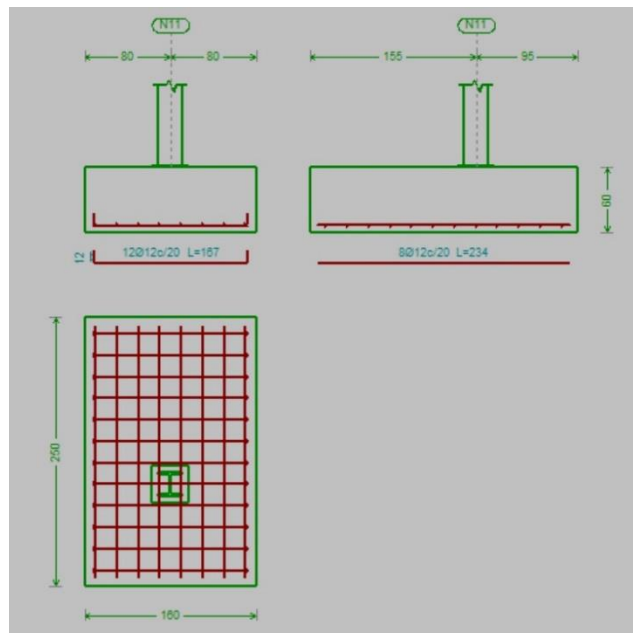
Vistas de una zapata rectangular excéntrica. Fuente: CYPE 3D.
